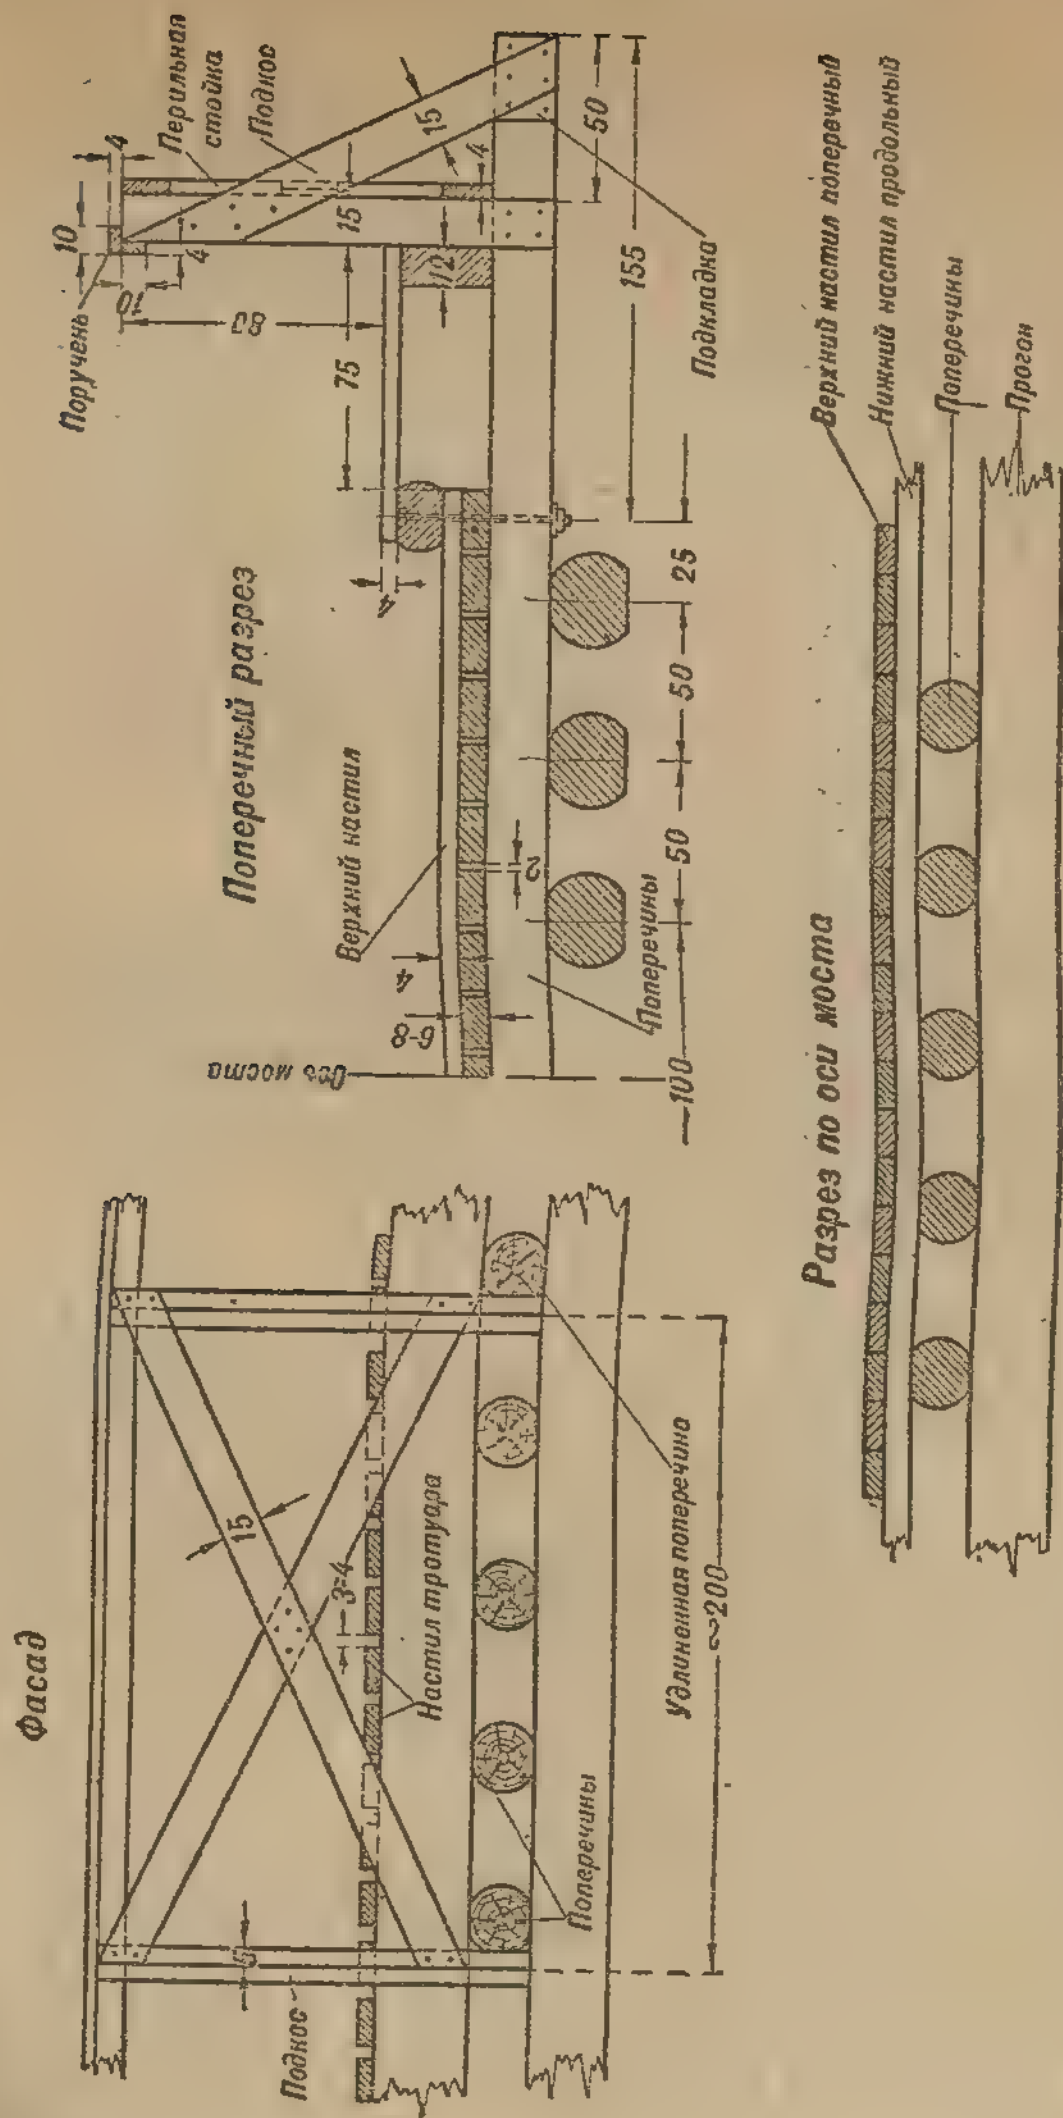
Конструкция проезжей части моста с перекрестным настилом.
